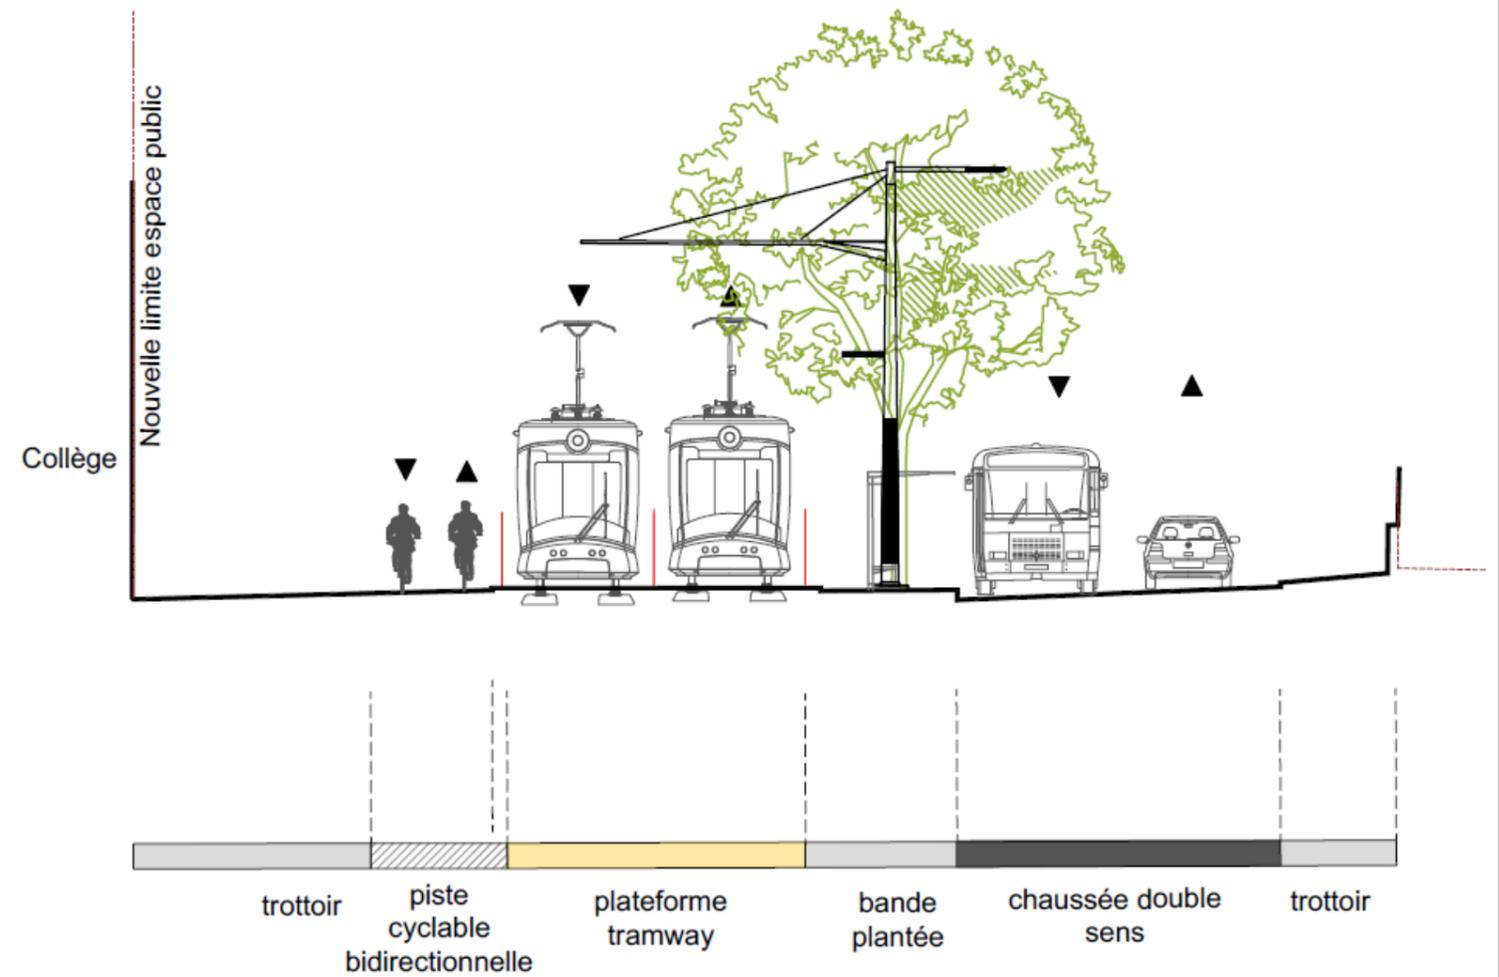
exemple de profil en travers du boulevard Schœsing au niveau de la trémie du tunnel
